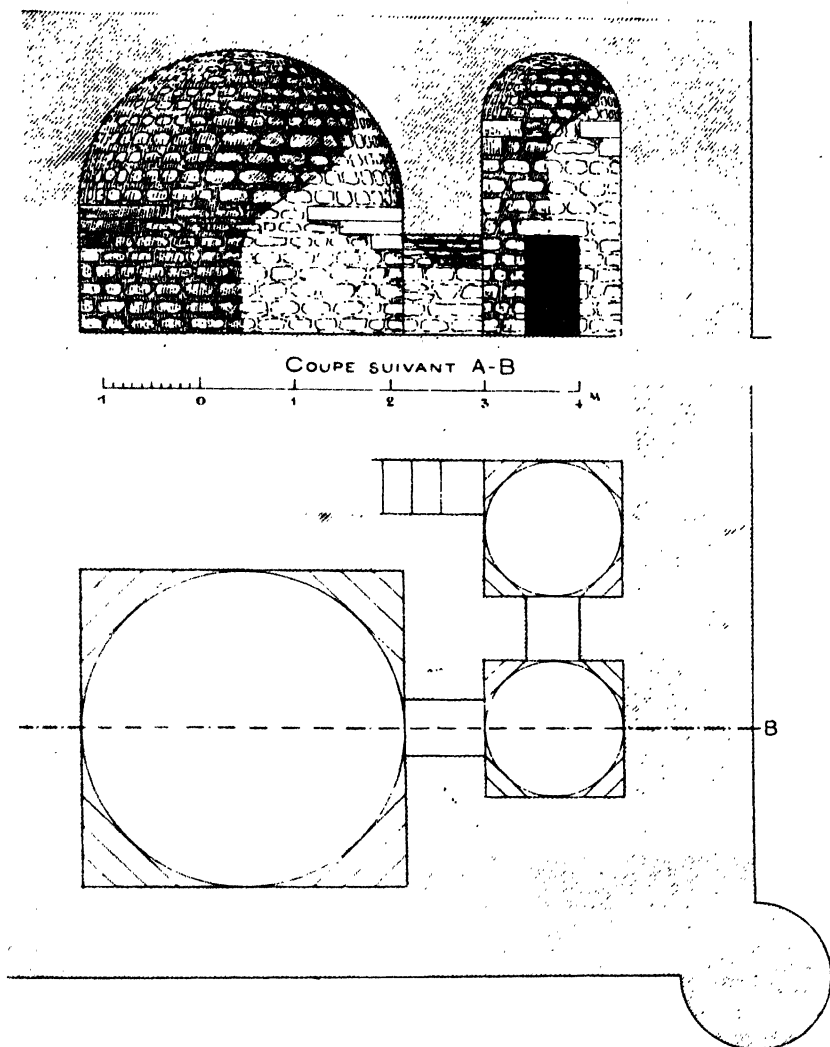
COUPLES SUR SOUBASSEMENT CARRÉ : PLAN ET ÉLEVATION.
